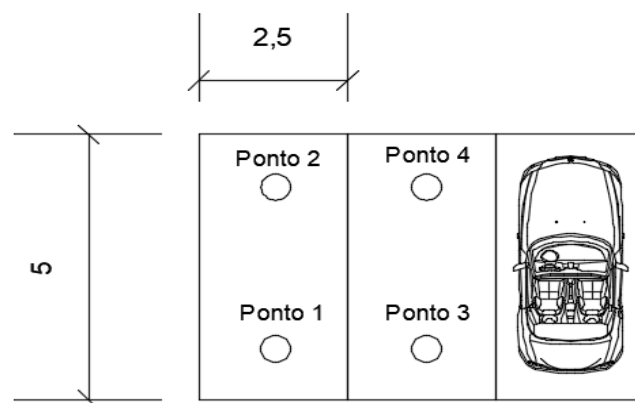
Representação em planta dos pontos do ensaio FWD
